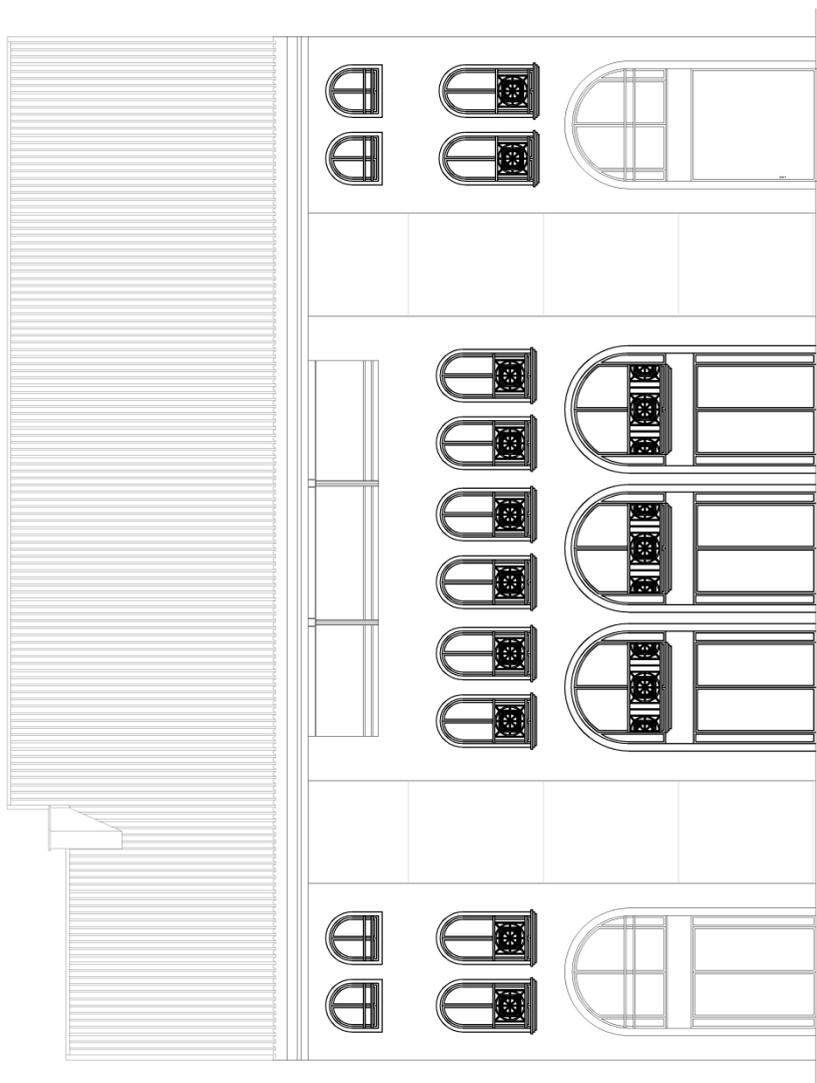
Alzado principal (fachada sur). 2002. AutoCAD.
